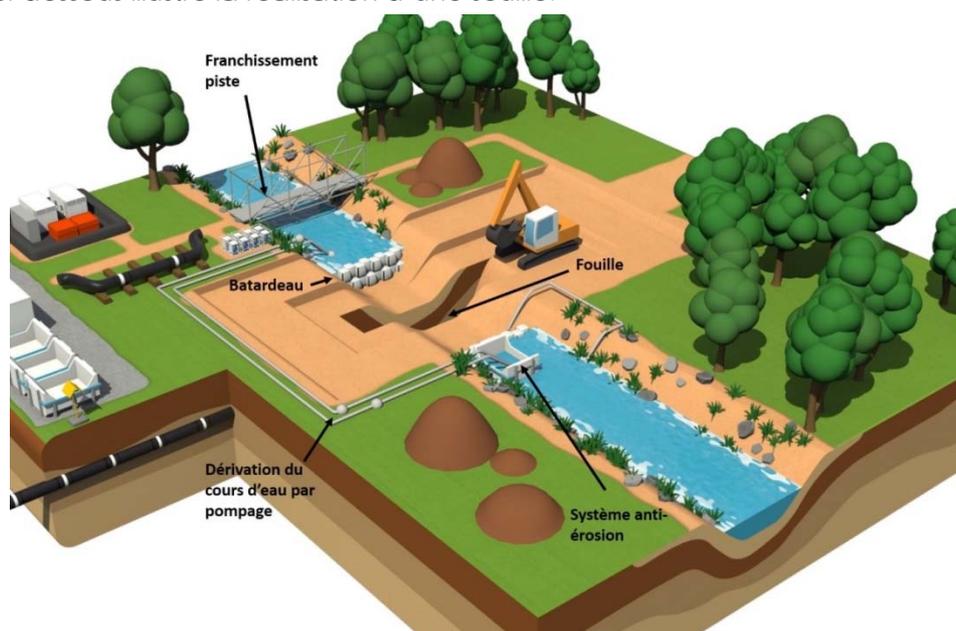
Schéma d'une traversée de cours d'eau en souille
